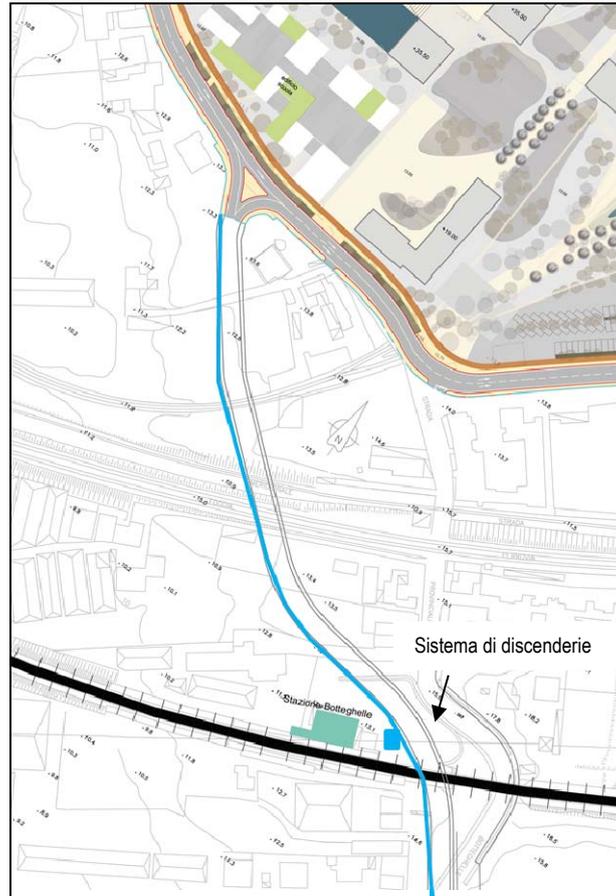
Individuazione planimetria del sistema di discenderie
